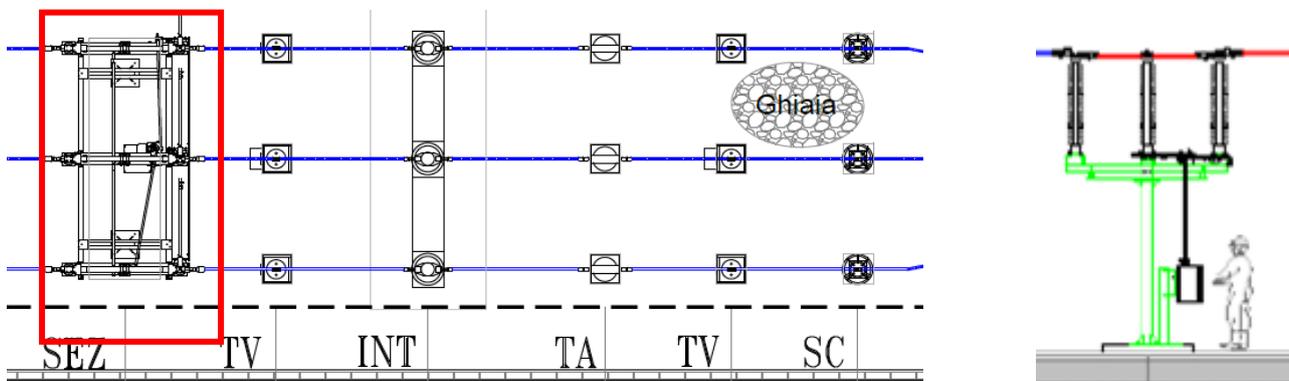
Tipico sezionatore tripolare – vista prospettica e planimetrica
